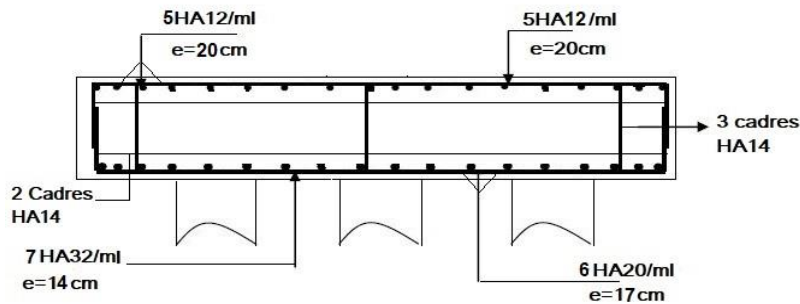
19 : Schéma de ferrailage de la semelle de la pile
